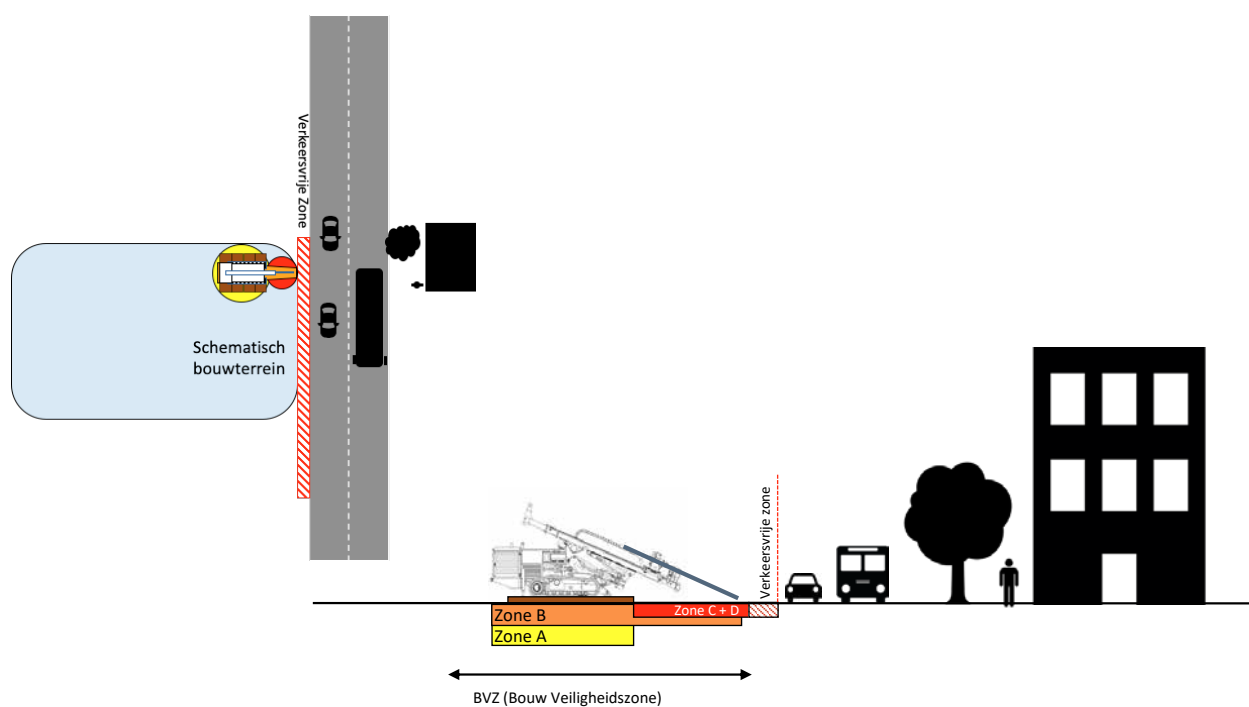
Overzichtstekening te lood funderen met PD-stelling/giekstelling & GLS-stelling/vouwstelling/sheetpilar – type sheetpilar (hoofdgroep B en C)
